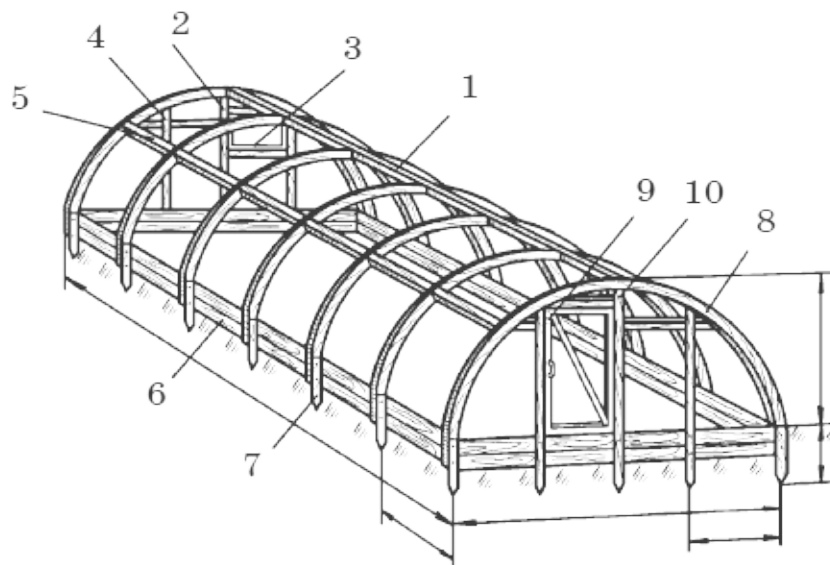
Арочный каркас теплицы: 1 — коньковый брус; 2 — стойка; 3 — форточка; 4 и 5 — распорки; 6 — основание теплицы; 7 — колышек; 8 — дуга; 9 — дверь; 10 — стойка
